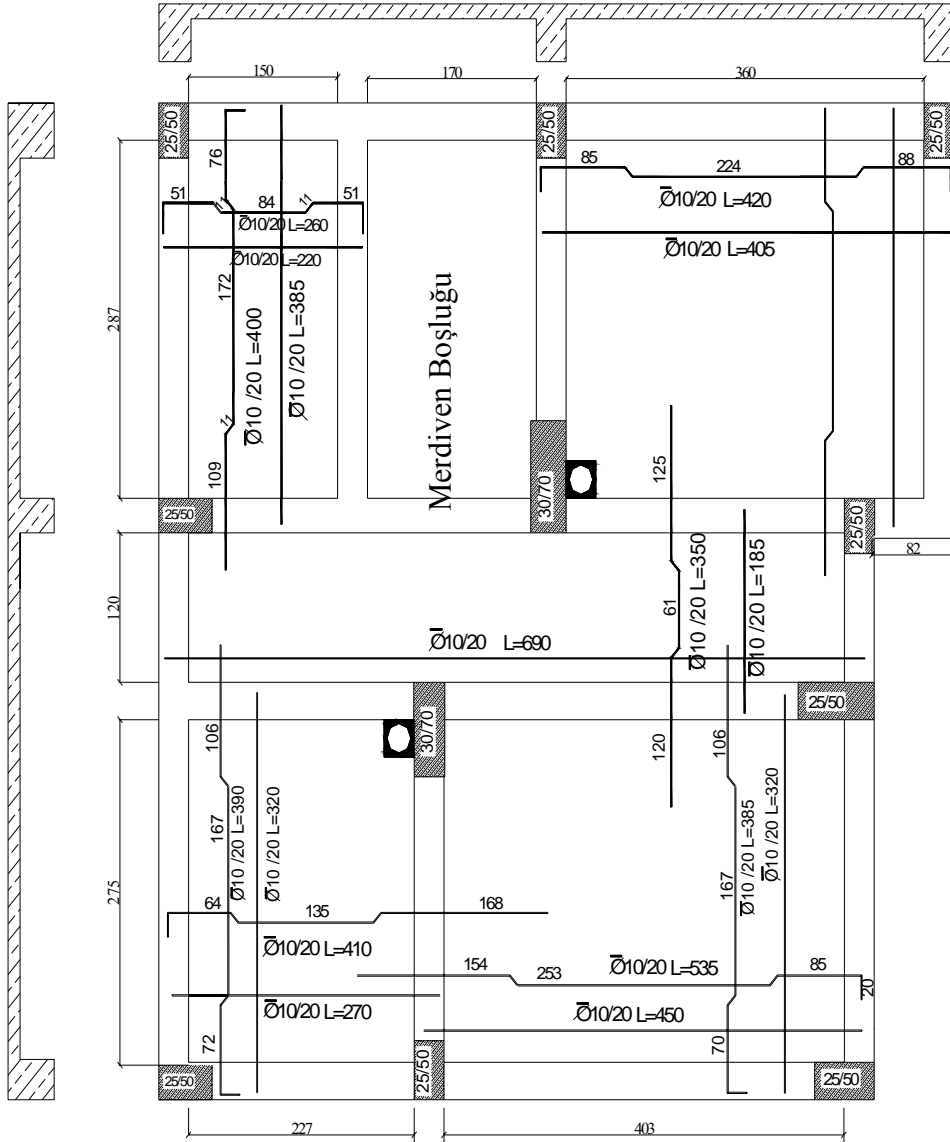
Konsol çelik donatı döşeme plan ve kesiti
